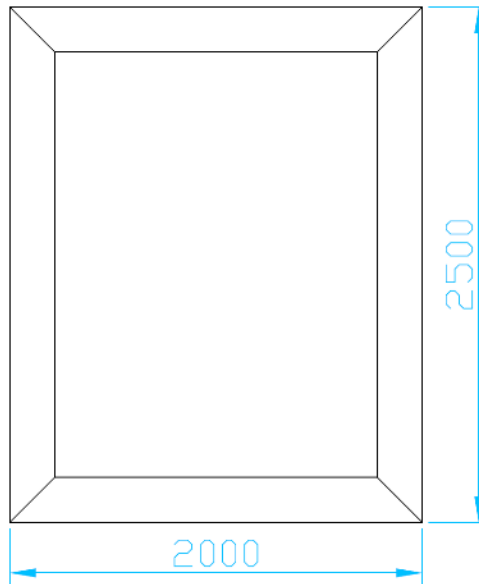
Vista en planta de poza solar en estudio. Medidas en [cm].
